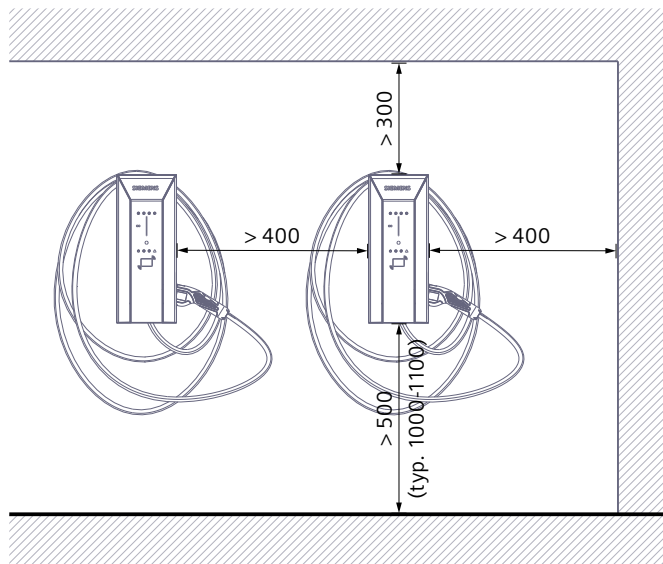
Distanze dalla parete e tra i Wallbox adiacenti
